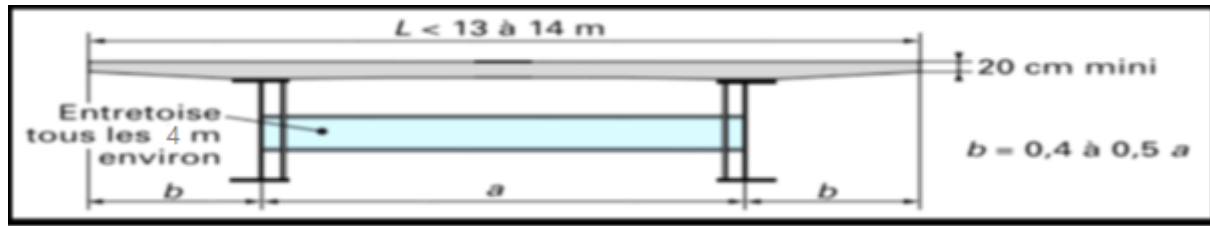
Coupe transversale de la variante 1 (SETRA, 1985).
